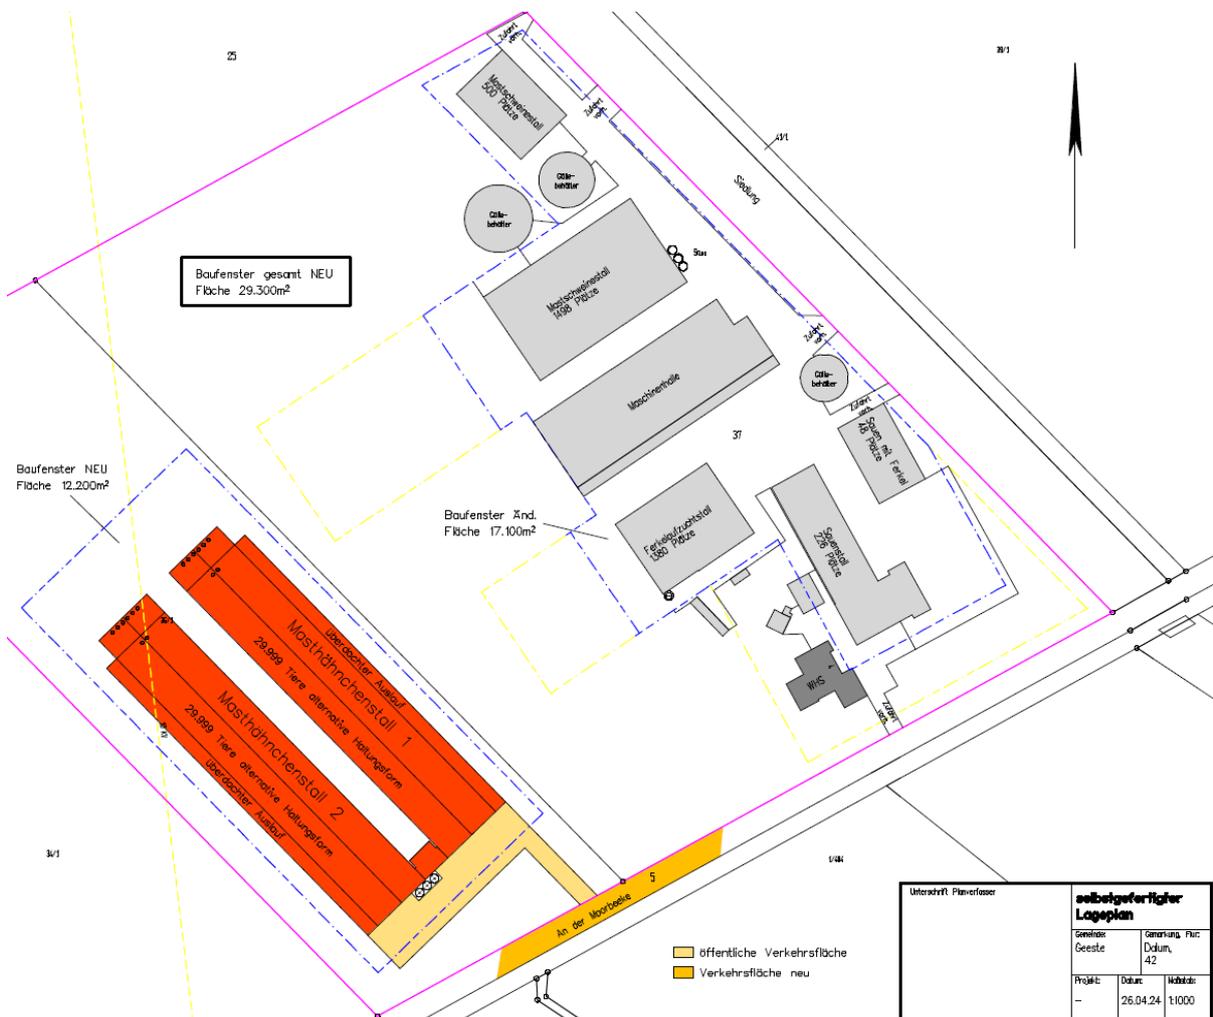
Lageplan zum Bauvorhaben (Kieselhorst 2024) (unmaßstäblich)
